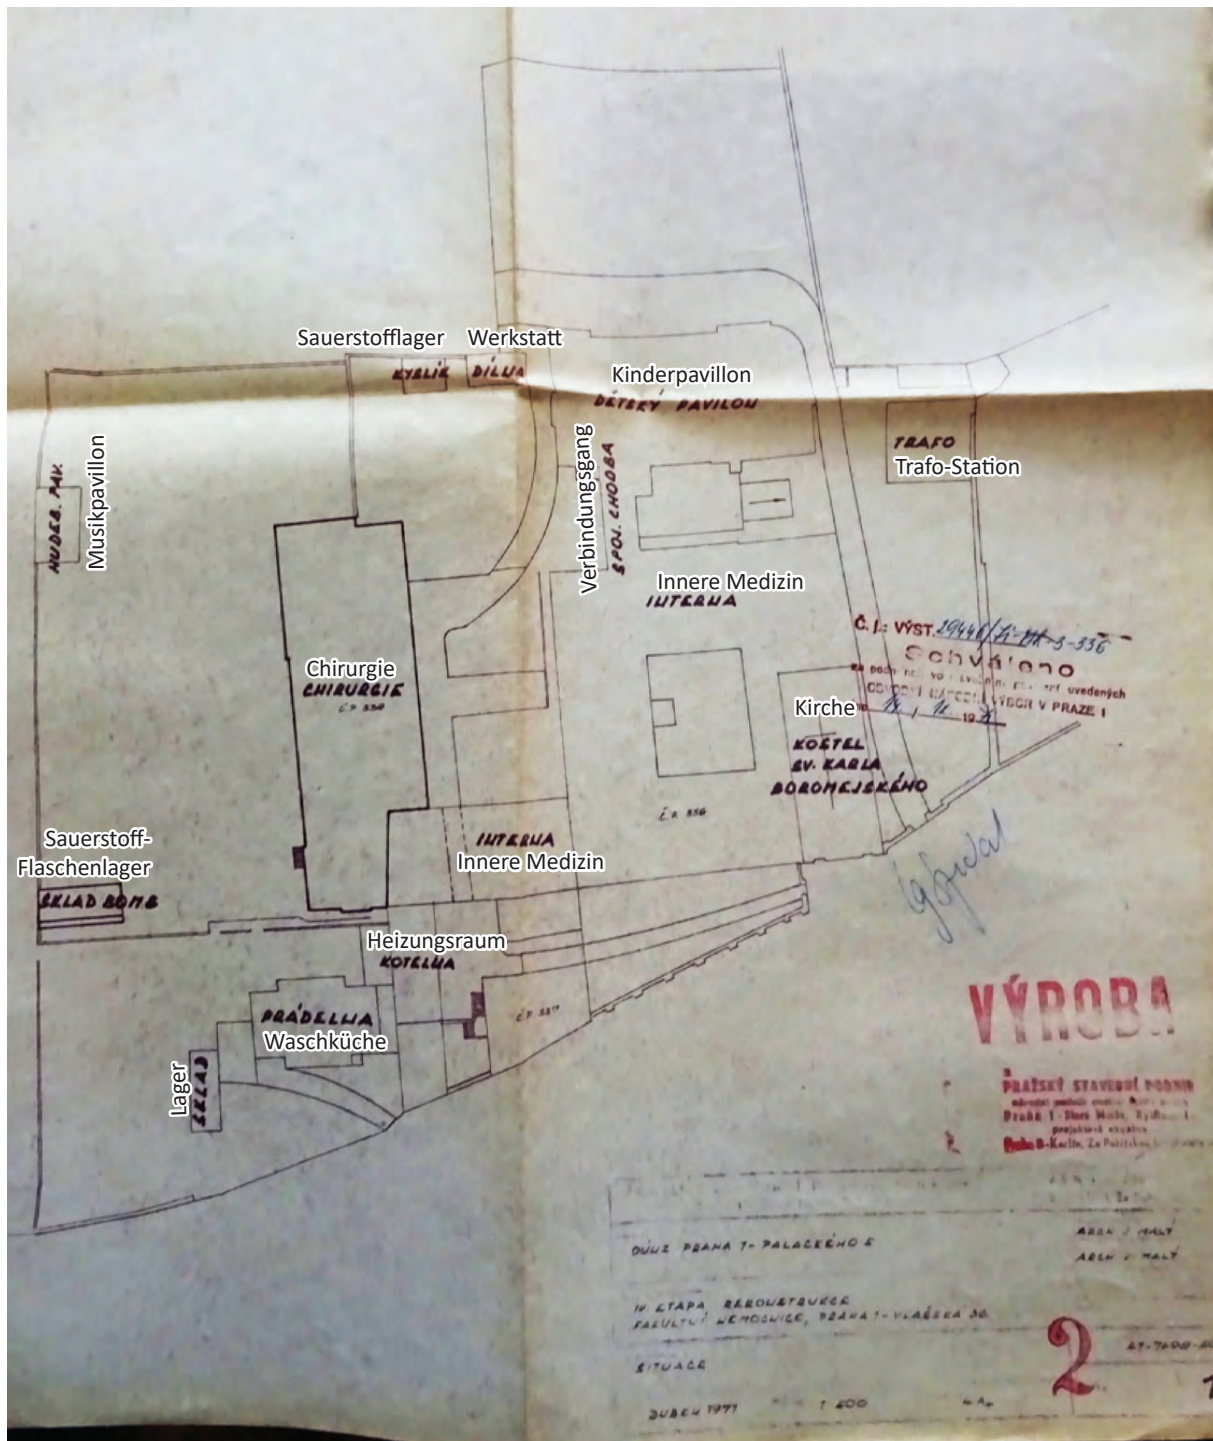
IV. Bauabschnitt der Umbaumaßnahme, Lageplan, Architekt J. Malý, Originalmaßstab 1:500, 1971
